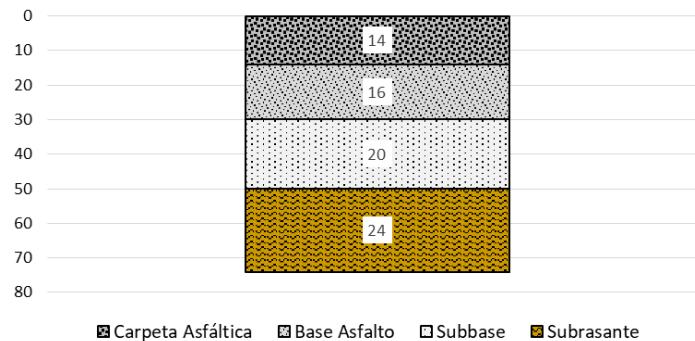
Estructura de Pavimento Flexible Propuesta
